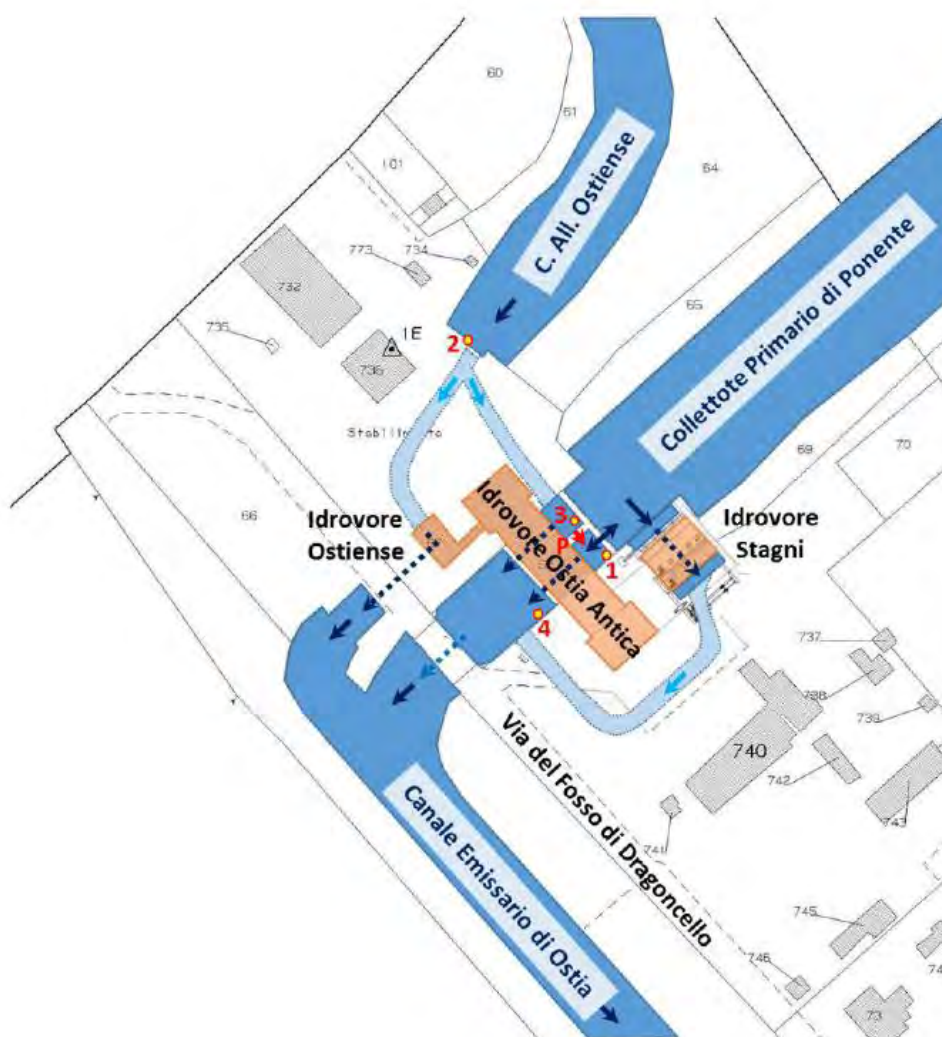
Planimetria dell'impianto idrovoro di Ostia
